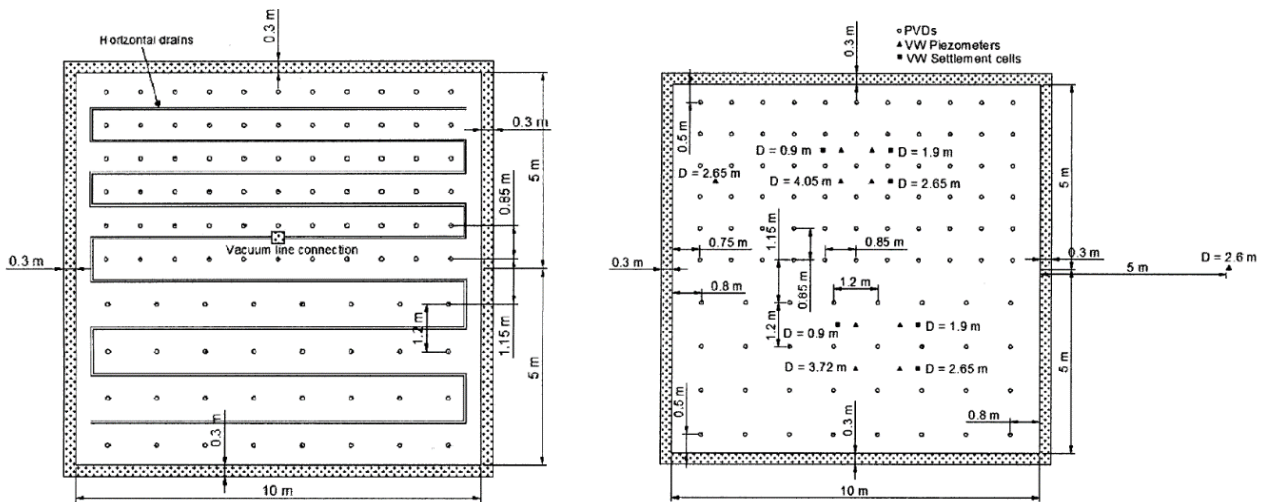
Vista en planta de sistema de aplicación de vacío: a) Sistema de distribución horizontal de la carga, b) Instrumentación en el área de estudio (Osorio et al. 2010).
